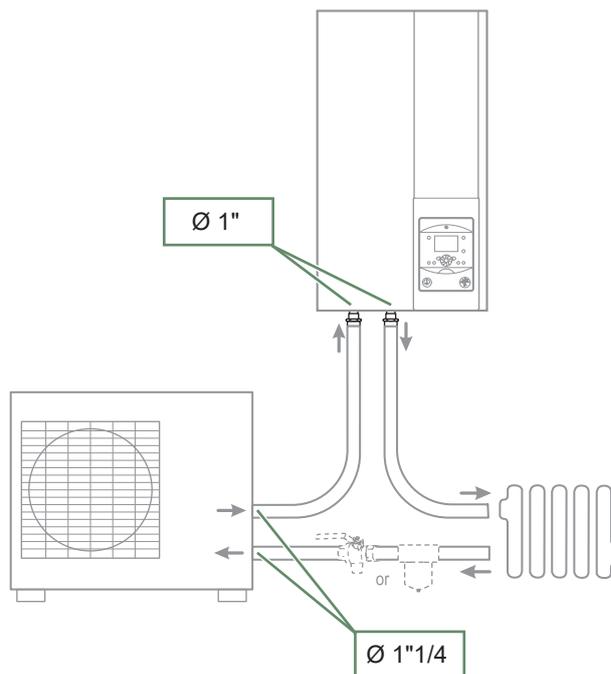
Durchmesser der Anschlussstücke der Rohrleitungen
